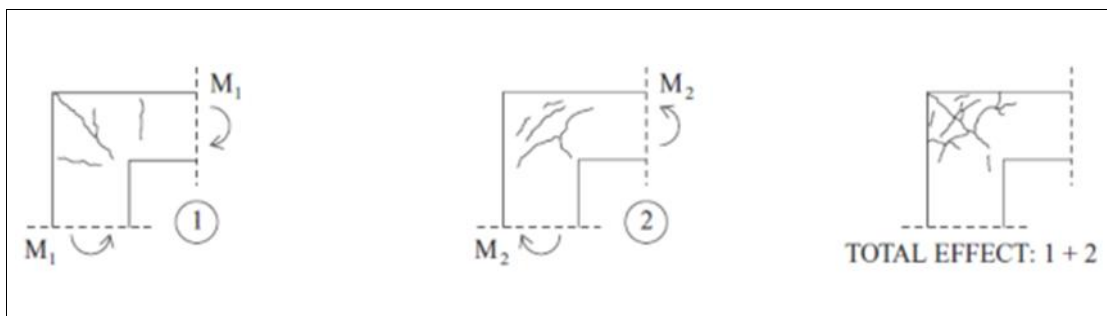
Types de dommage sismique des assemblages poteaux- poutre extérieur en L [27]
